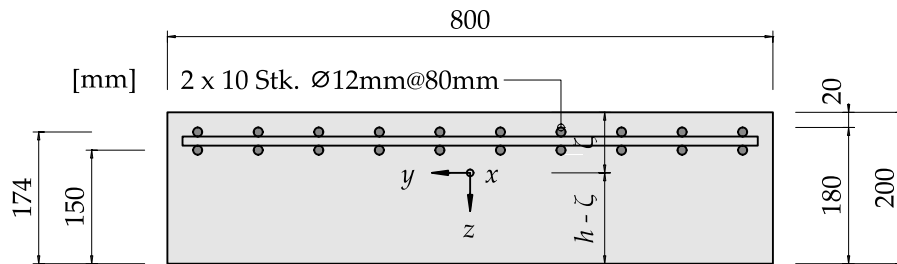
Querschnitt des Plattenstreifens dargestellt mit Zugbewehrung, ohne Schubbewehrung
